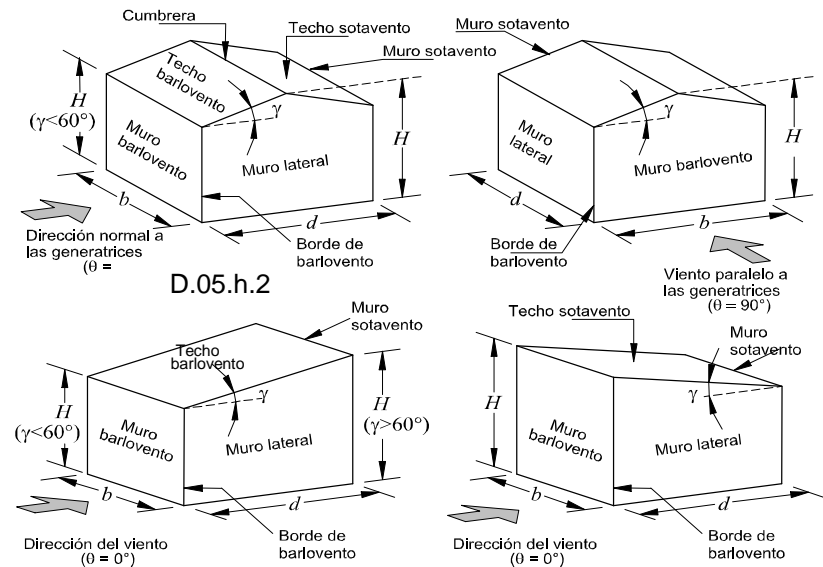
Definición de parámetros de construcciones con planta cerrada.
